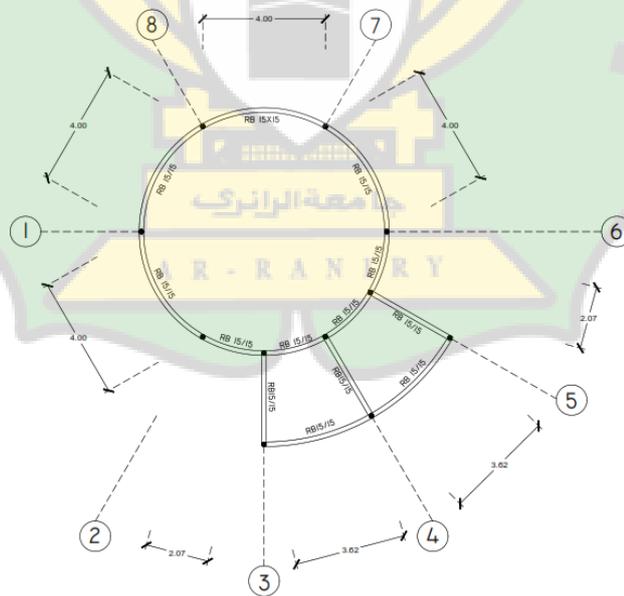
Denah Plat Lantai *Deluxe Room
